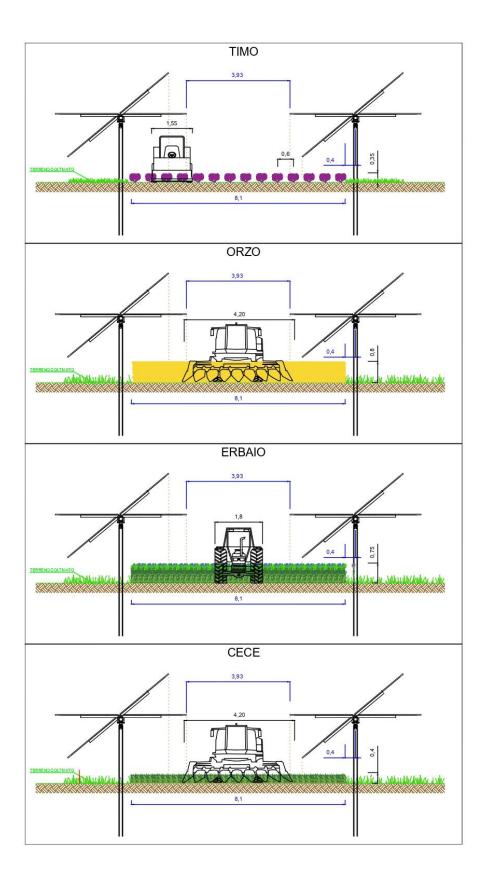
Rappresentazione del prospetto frontale delle colture di timo, orzo, erbaio e cece
